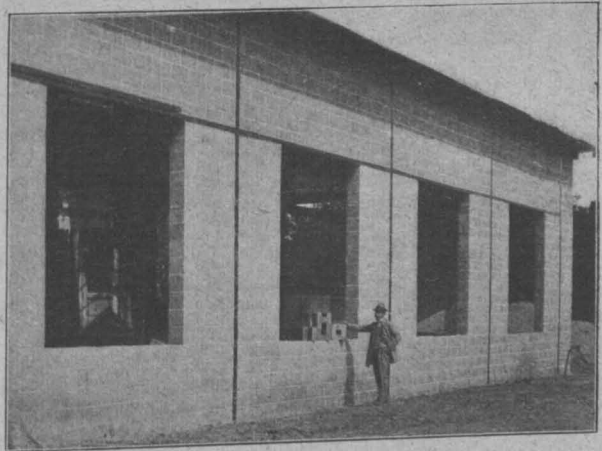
Wand eines Hallenbaues für Borsig in Tegel. Betonhohlsteine Bauweise Tilgner.
